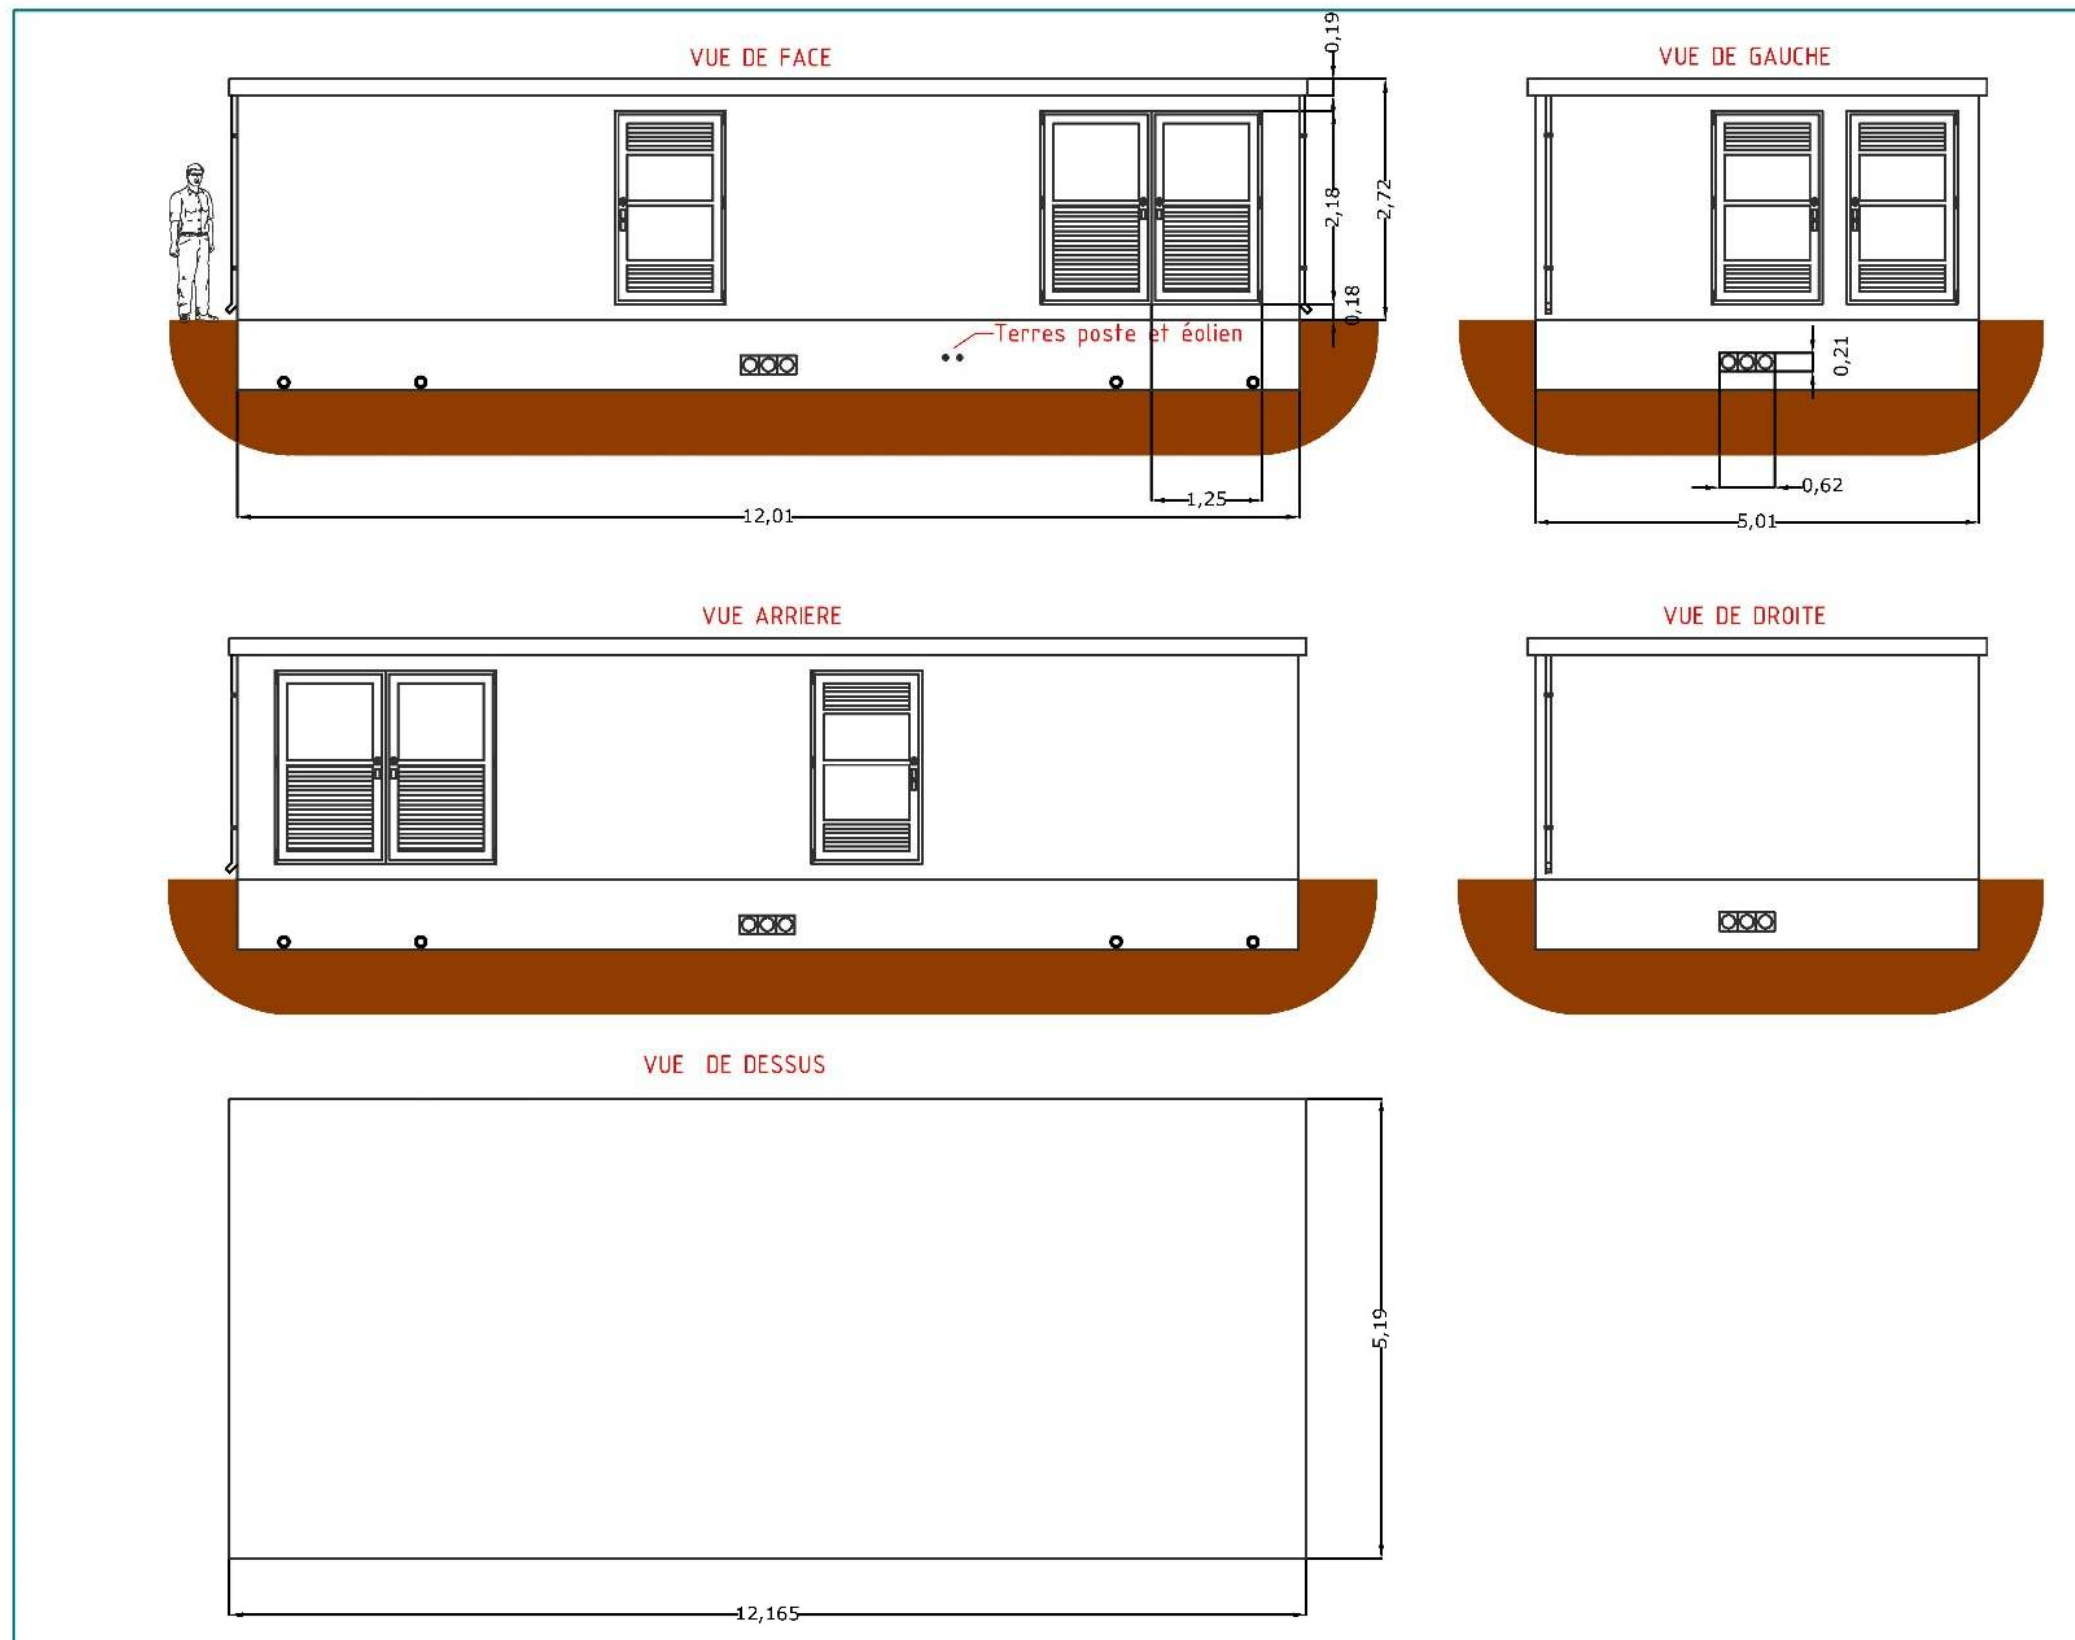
Exemple de plan d'un poste de livraison de 5 x 12 mètres
